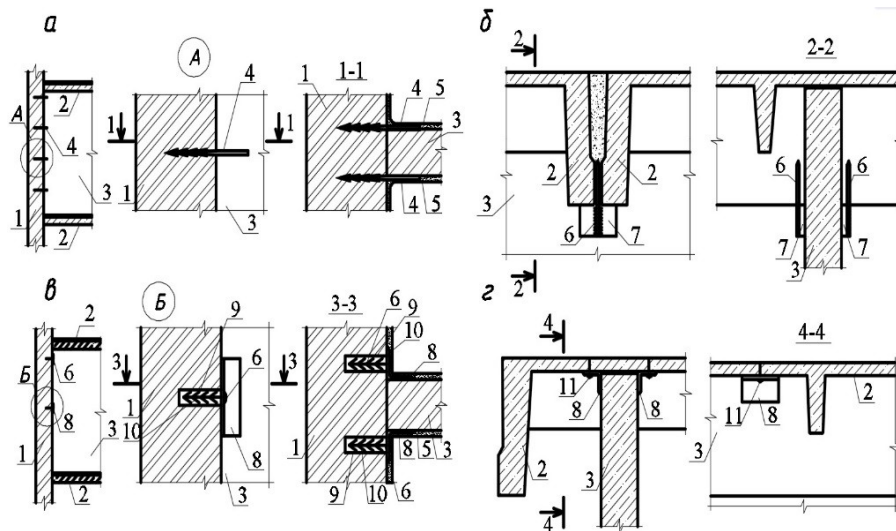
Дополнительные крепления стен и перегородок: *а* – забивка стальных анкеров в швы кладки; *б* – крепление перегородок к ребристым панелям; *в* – установка стальных уголков и анкеров; *г* – крепление перегородок к ребристым панелям уголками на дюбелях; 1 – каменная стена; 2 – железобетонное перекрытие; 3 – перегородка, не имеющая достаточного крепления; 4 – стальные анкеры-ерши $\text{Ø}10\text{--}12$ мм, забиваемые в швы кладки с шагом 400 мм; 5 – штукатурка; 6 – анкеры-ерши, забиваемые в деревянные пробки в швах между продольными ребрами панелей; 7 – стальные пластины, привариваемые к анкерам; 8 – стальные уголки-держатели с отверстиями; 9 – скважины, высверленные в кладке стены с шагом 400 мм; 10 – деревянные пробки, установленные в скважины; 11 – дюбели
